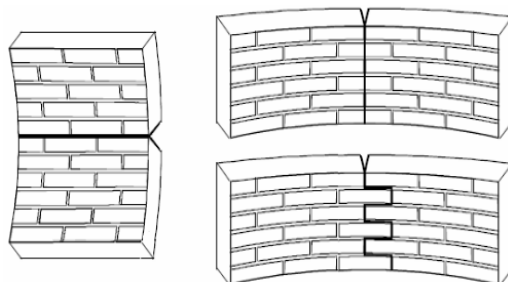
Plano de rotura paralelo às juntas de assentamento e plano de rotura perpendicular às juntas de assentamento (Gouveia & Lourenço, 2006)
